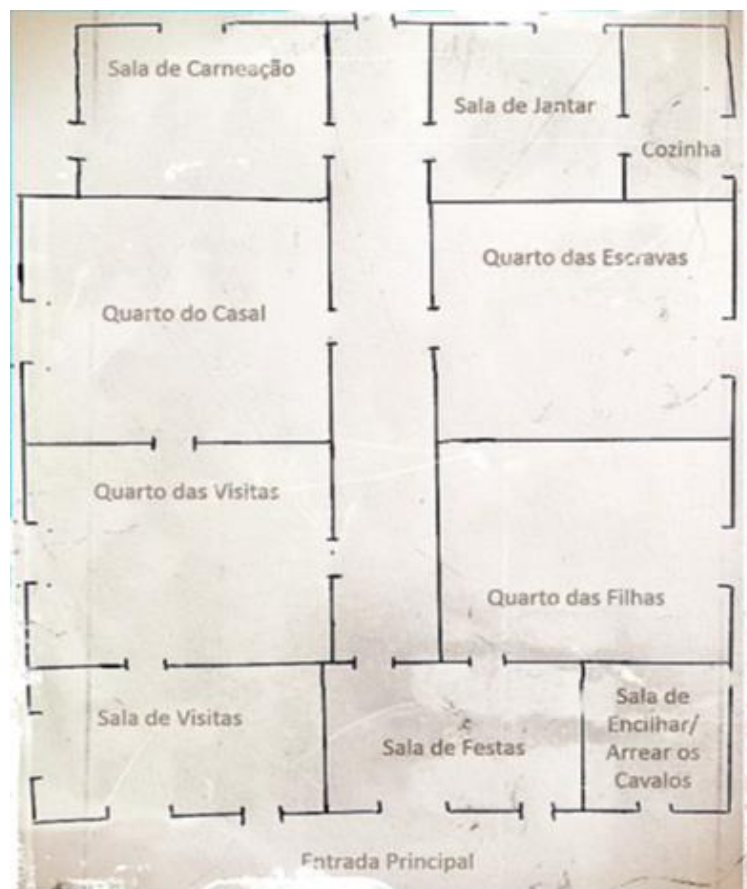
Planta baixa da casa de pedras de Curalinhos (50x24m aprox.), paredes de 30/40 cm de espessura
